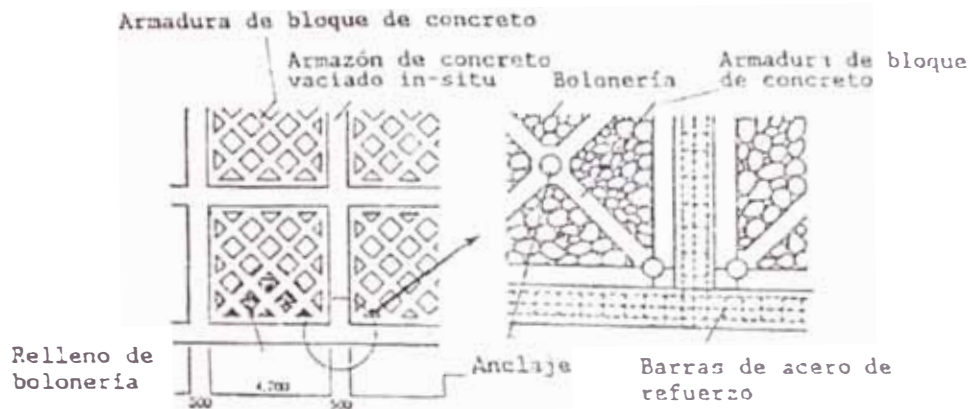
UN EJEMPLO DE ARMAZON DE CONCRETO VACIADO IN-SITU (Unidad: mm)
